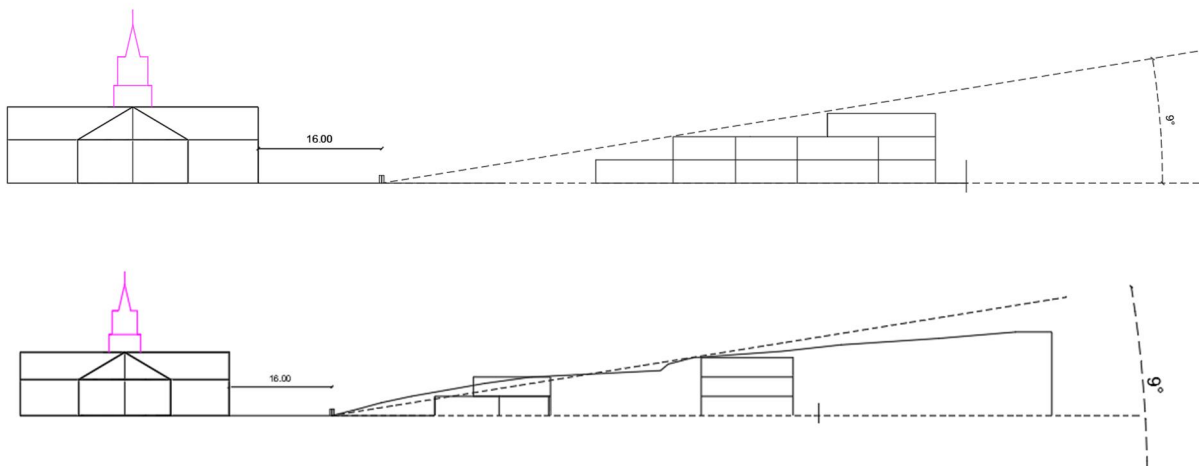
Oppriss Betel – Leilighetsbygg - Kirka
